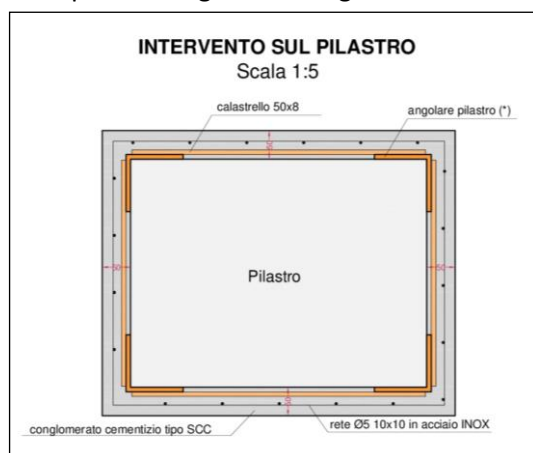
particolare dell'intervento sui pilastri, consistente nella realizzazione di una blindatura con SCC, armato con carpenteria in angolari e calastrelli e rete elettrosaldada inox.
